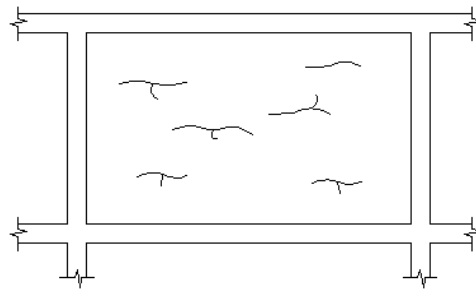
Fissuras horizontais provenientes da expansão dos tijolos.
